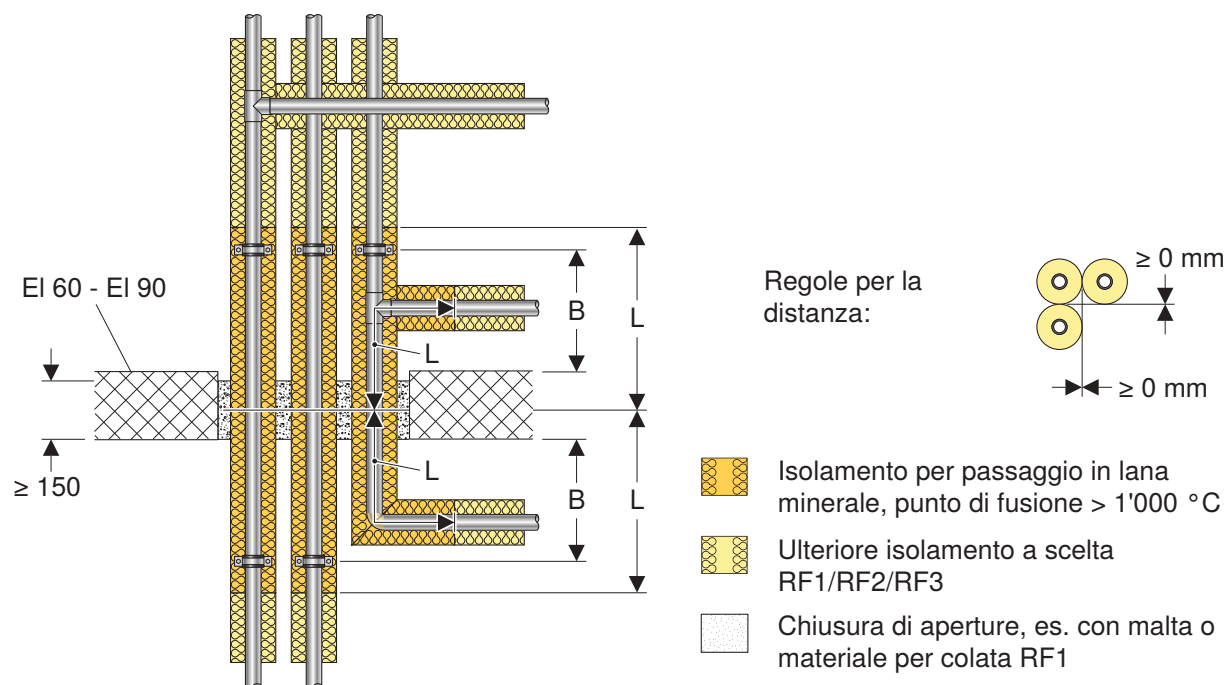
Attraversamento di soffitto con Geberit Mepla o Geberit PushFit e isolamento Rockwool 800
